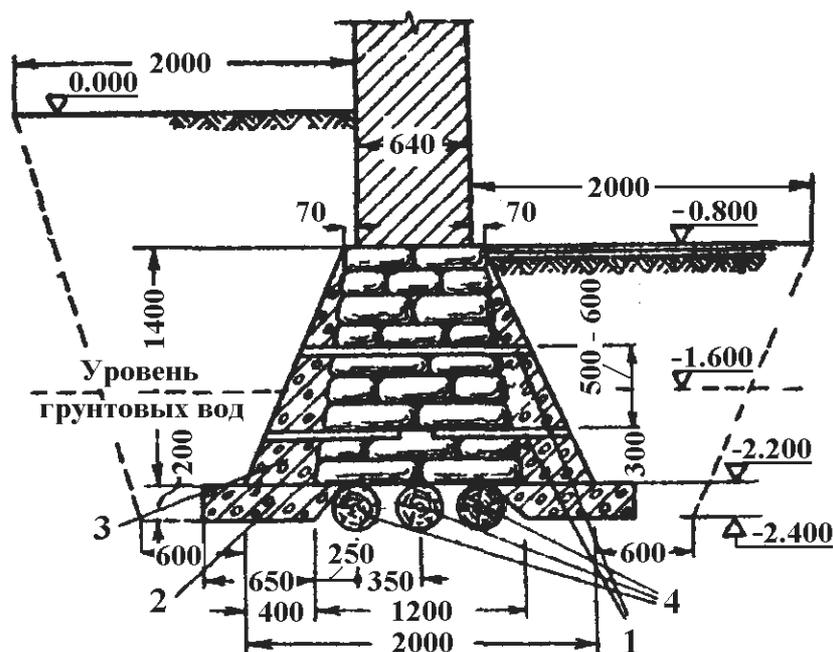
Конструктивное решение по уширению подошвы фундамента:
